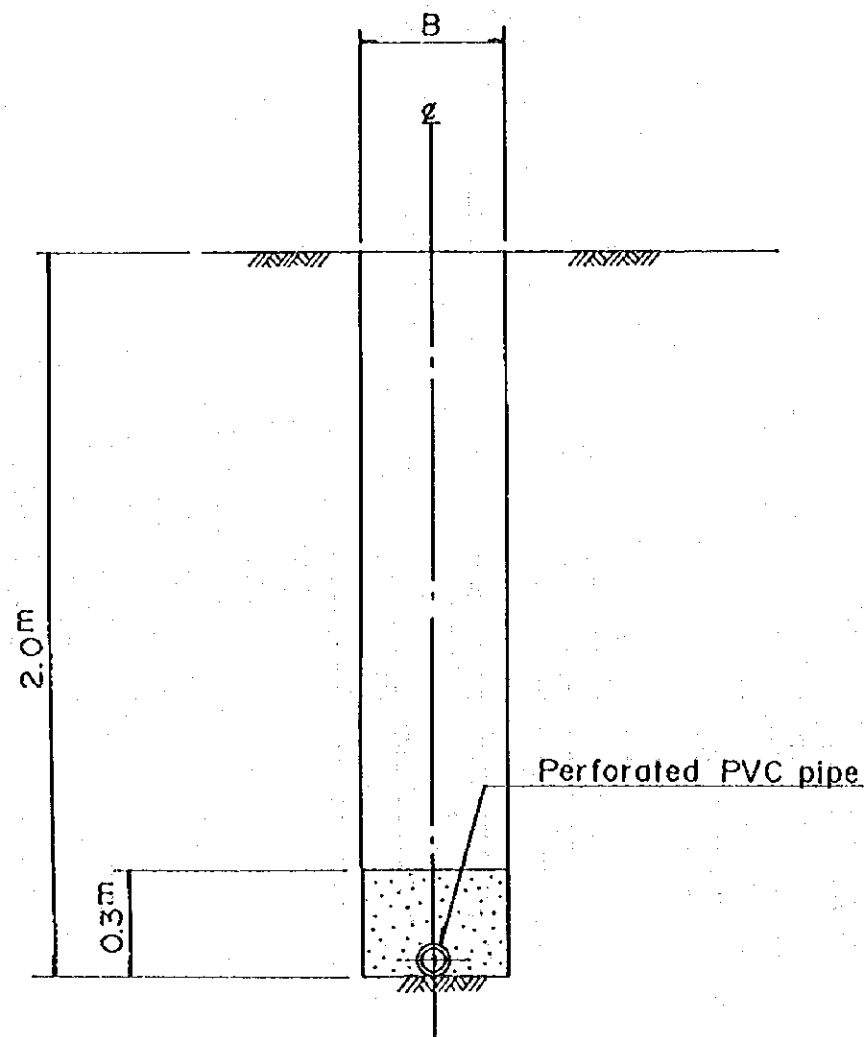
Plan standard d'ouvrage de distribution d'eau
